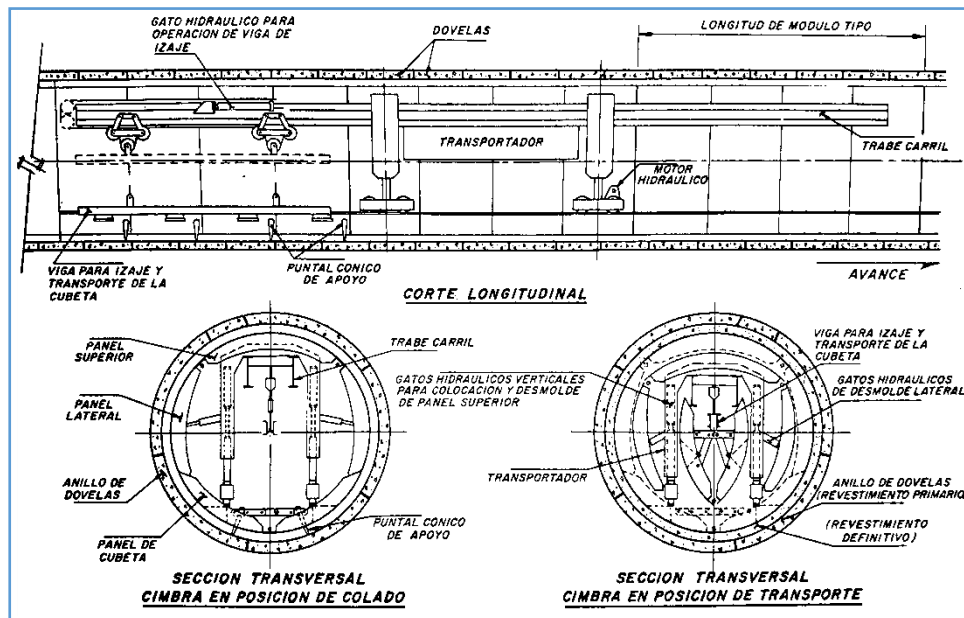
Cimbra telescópica para revestimiento definitivo (Orozco J, 1986).
